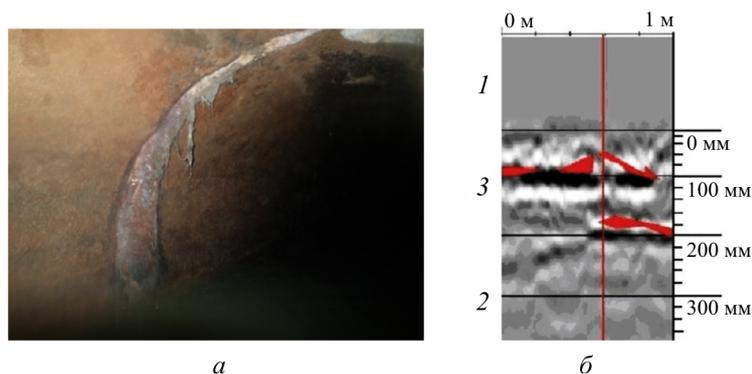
Дефект в виде расслоения конструкций: *a* – признаки напорных течей; *б* – фрагмент радарограммы с признаками расслоения конструкций тоннеля: 1 – тубинговая обделка; 2 – железобетонная рубашка; 3 – слой напорной воды
